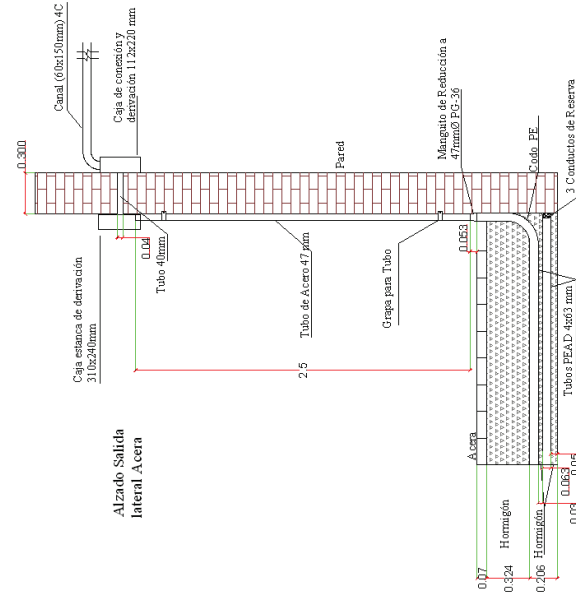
Alzado salida lateral a fachada de la Red de Acceso
